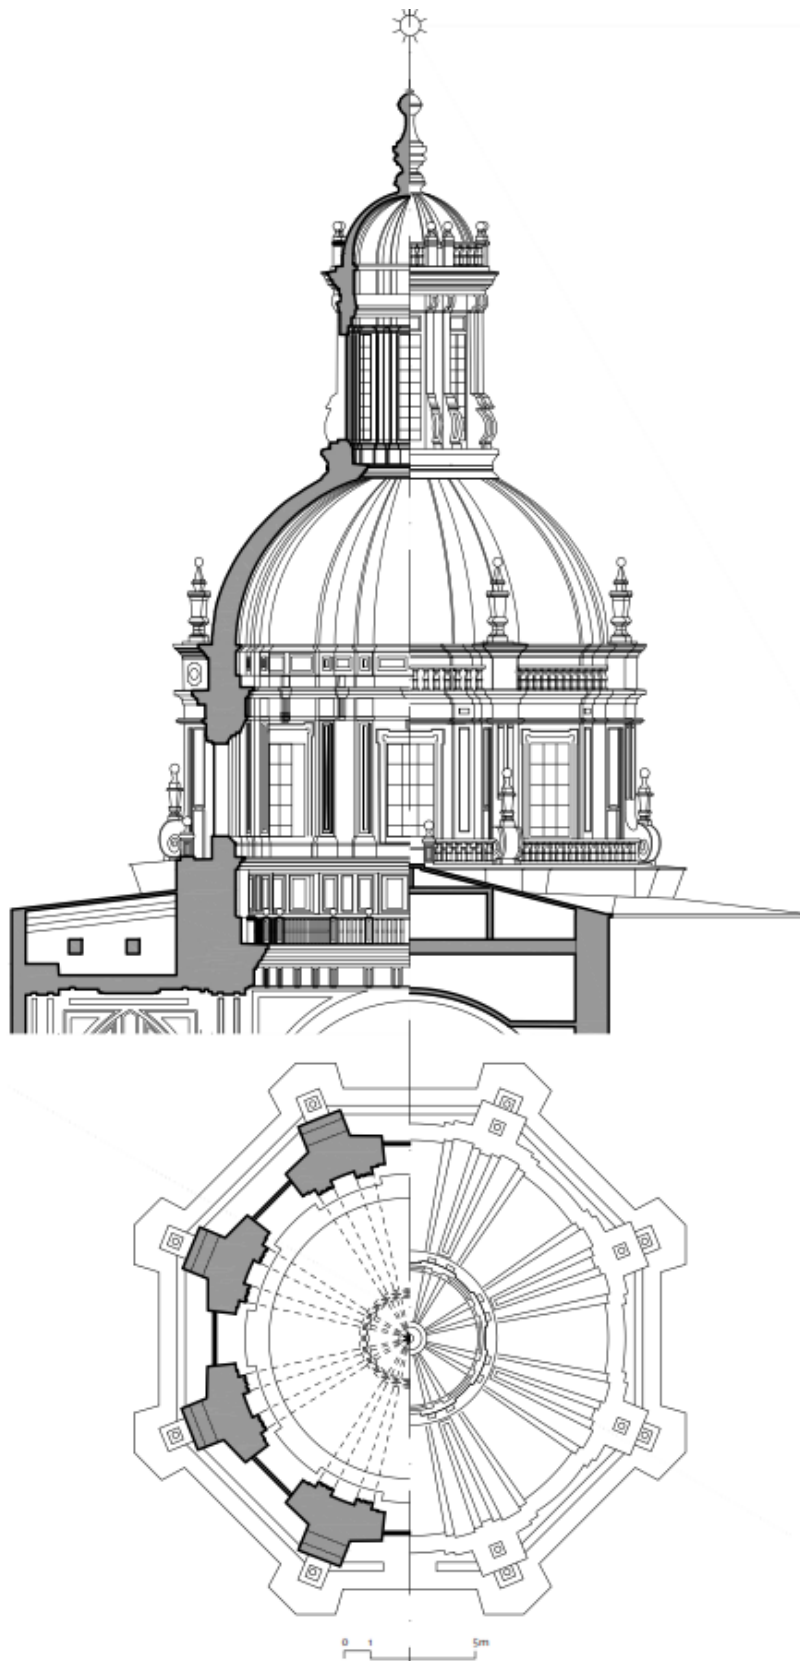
Relación entre el interior y el exterior de la cúpula en vista alzado y planta. Elaboración propia.
